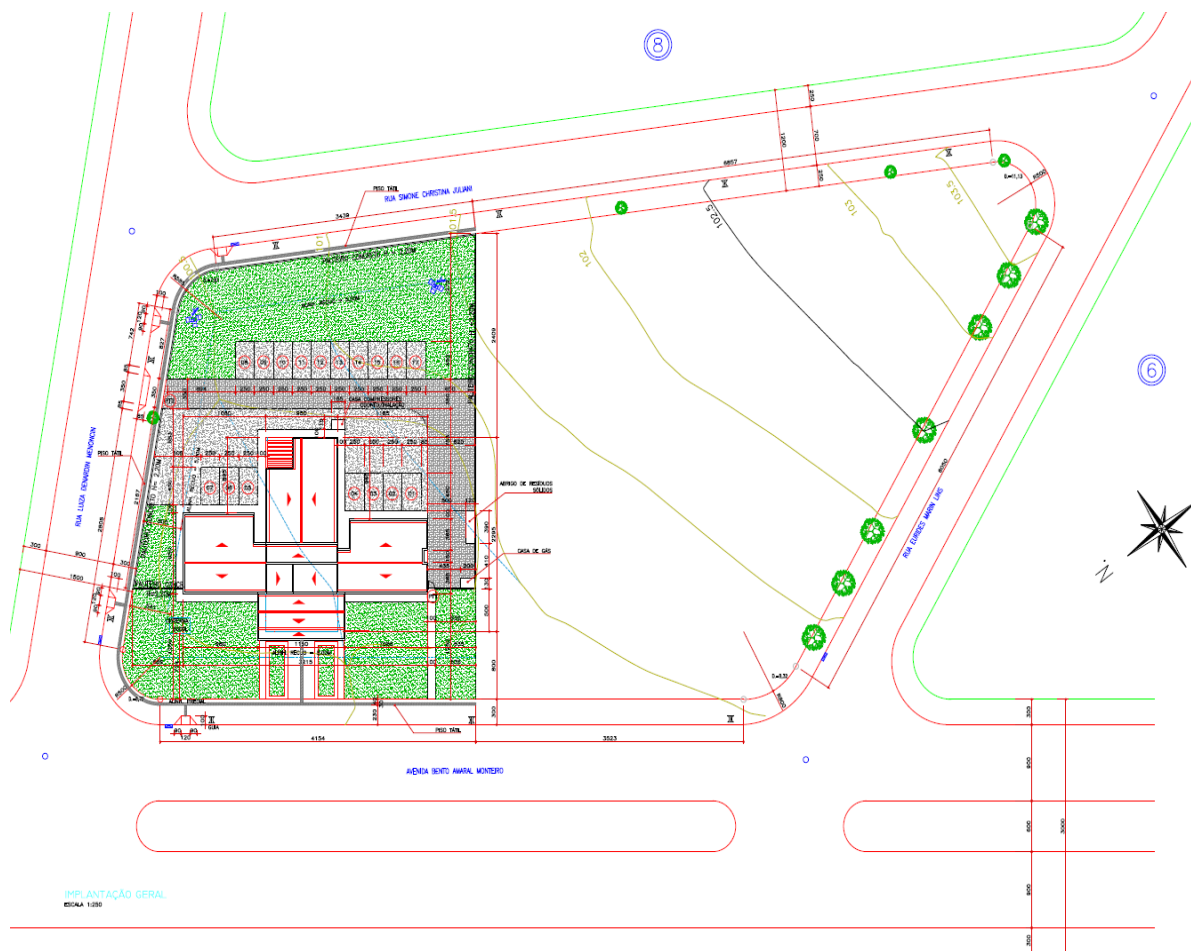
Projeto de implantação da UBS na área denominada “Praça 01”:
